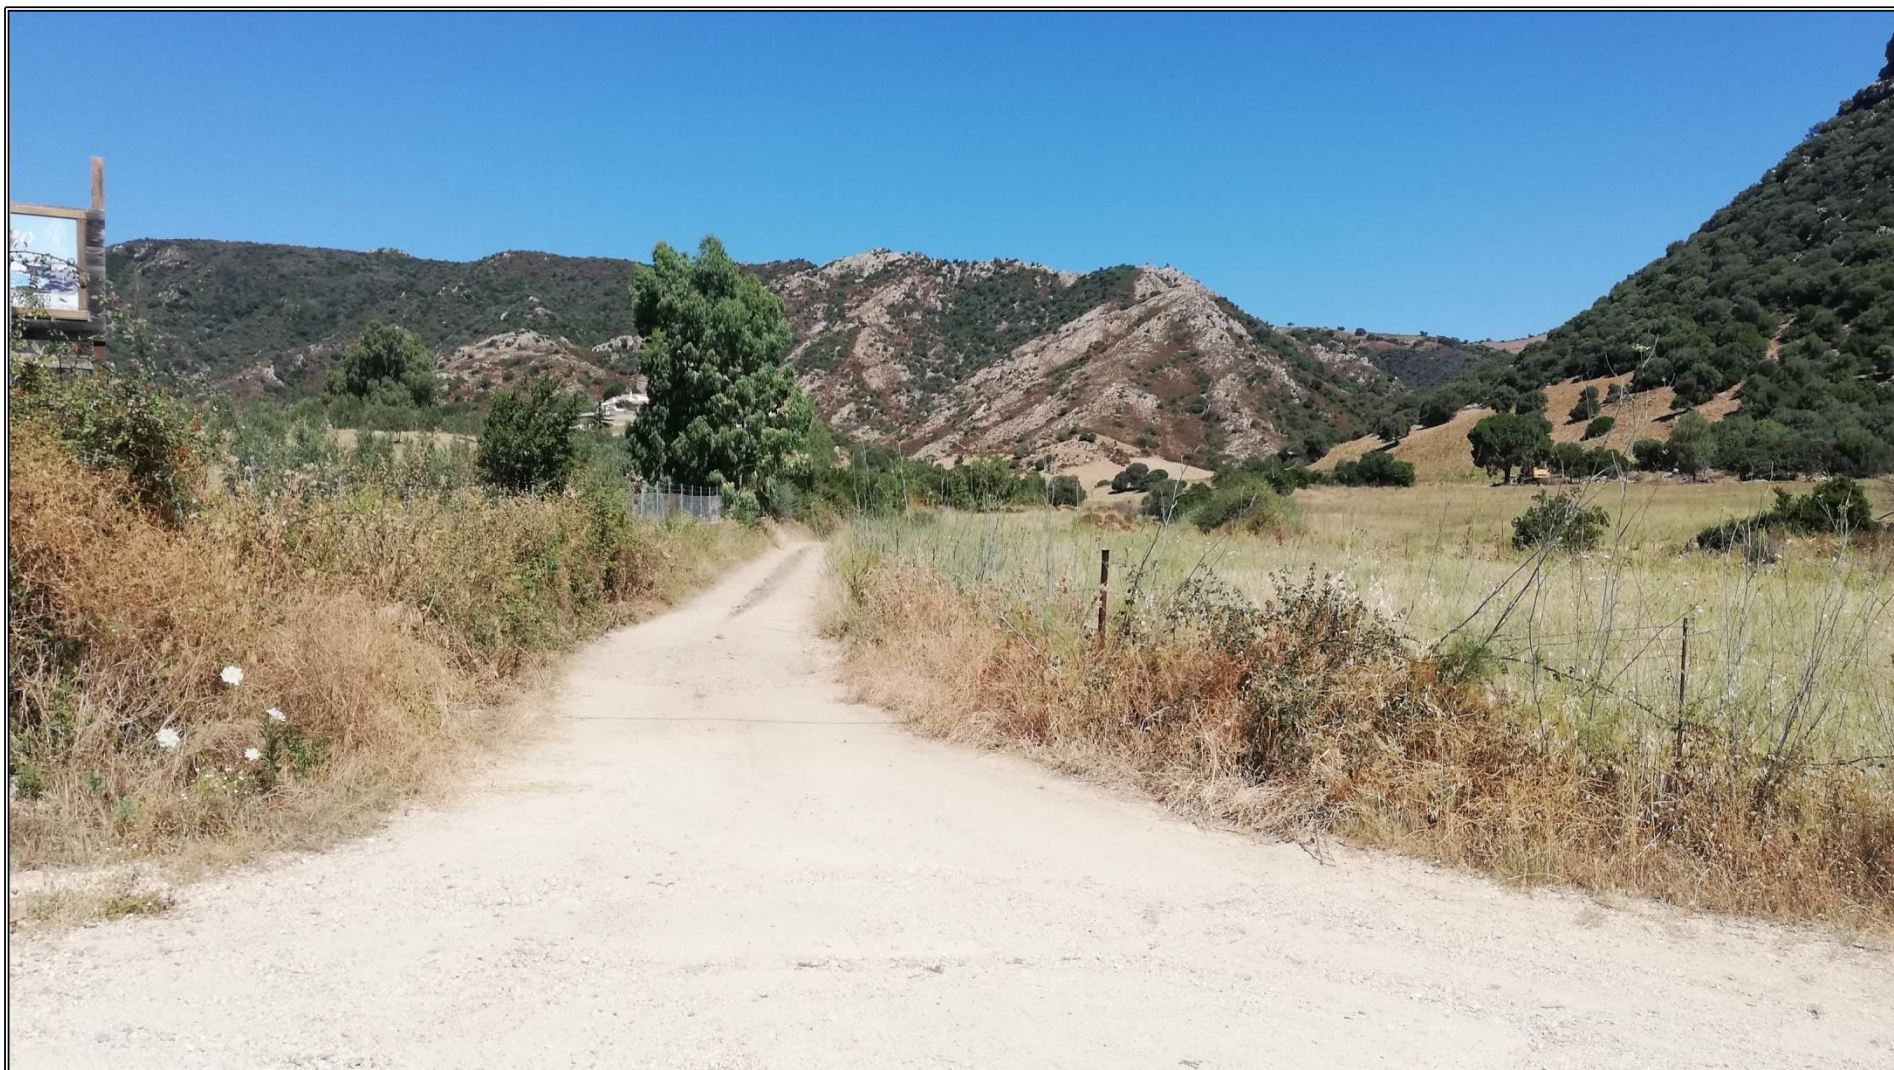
Strada di accesso al cantiere di Muntone e sullo sfondo a Sinistra la parte alta del cantiere di Muntone.
